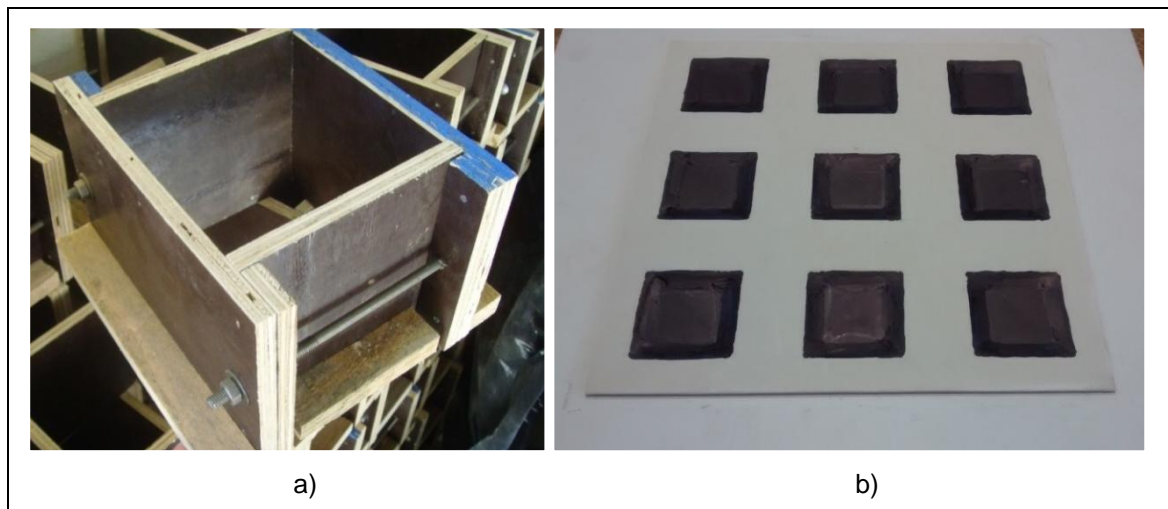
Fôrma dos blocos de concreto: a) Caixa lateral; b) Fundo da fôrma
